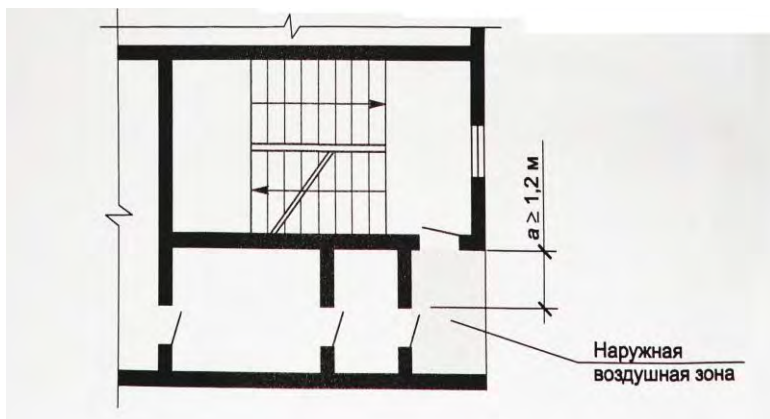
Пример устройства лестничной клетки типа Н1 с вариантом размещения дверей наружной воздушной зоны в плоскостях, расположенных под углом друг к другу:
